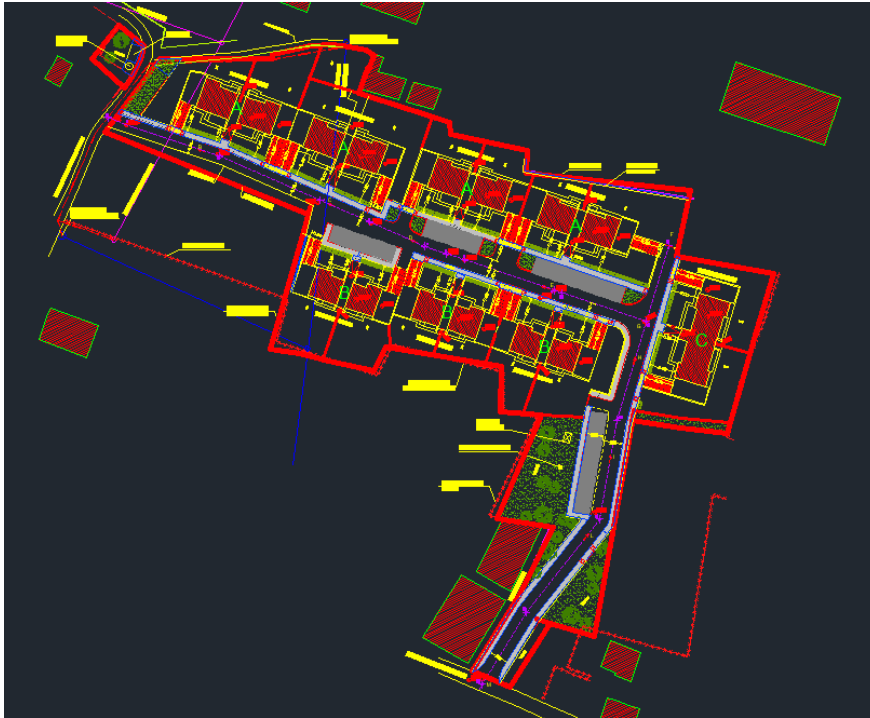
Estratto della tavola di progetto planimetria generale, con indicazione dettagliata dei manufatti edilizi e delle opere accessorie per il complesso residenziale del PEEP Bovalico.
